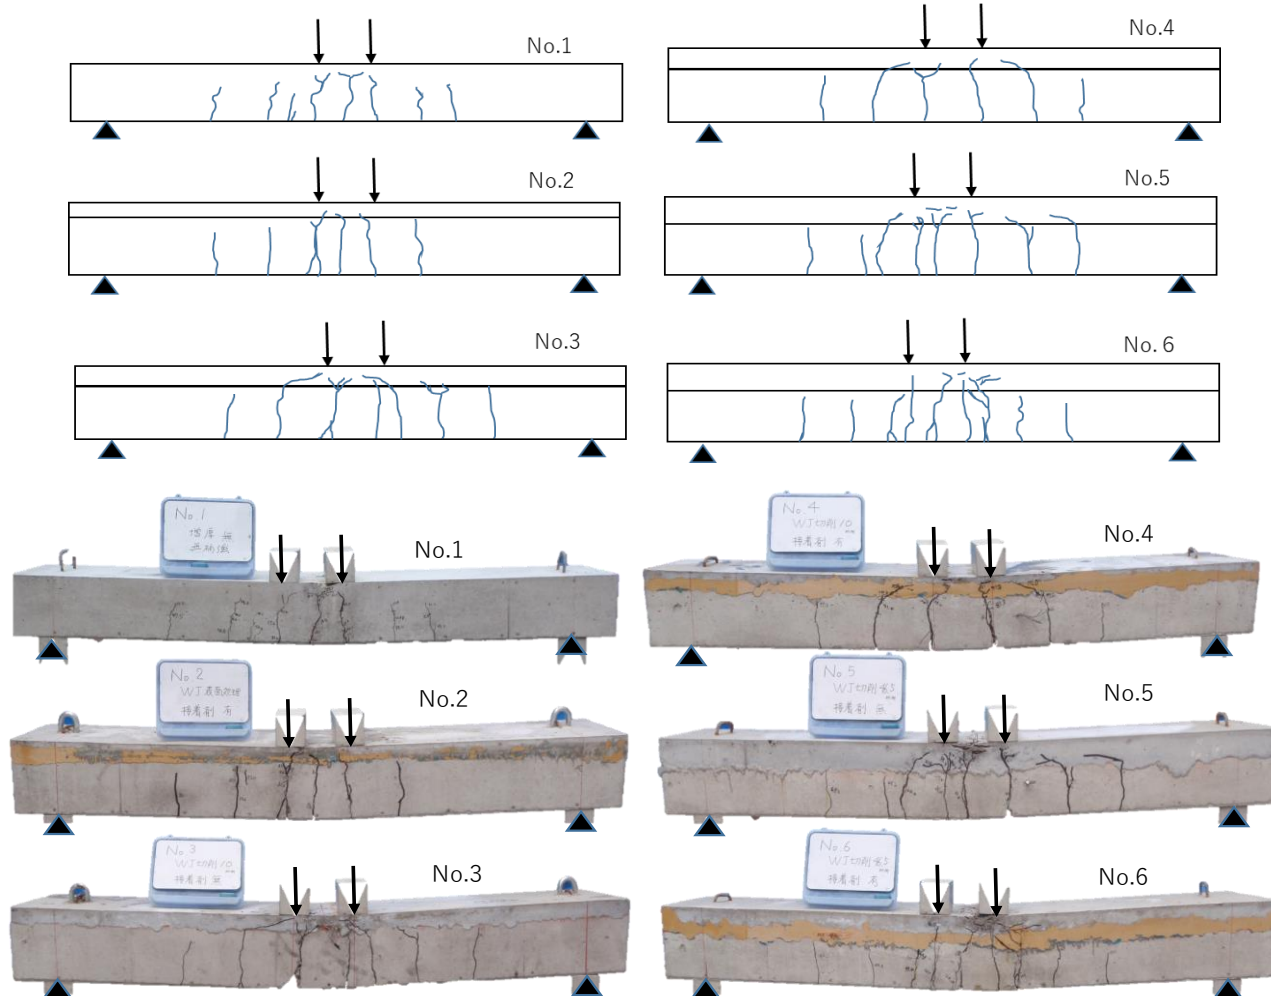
RC 試験体の荷重試験終了後のひび割れと破壊の状況（上：スケッチ，下：写真）
